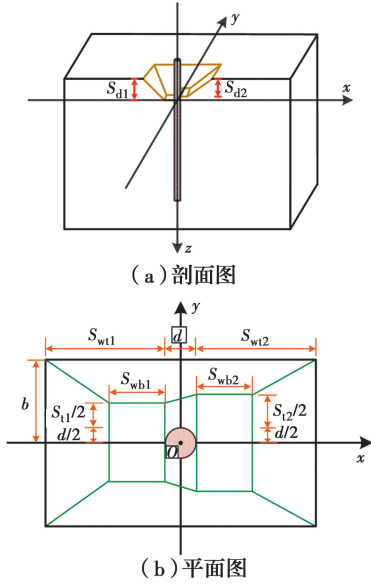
非对称局部冲刷坑简化模型剖面图和平面图
